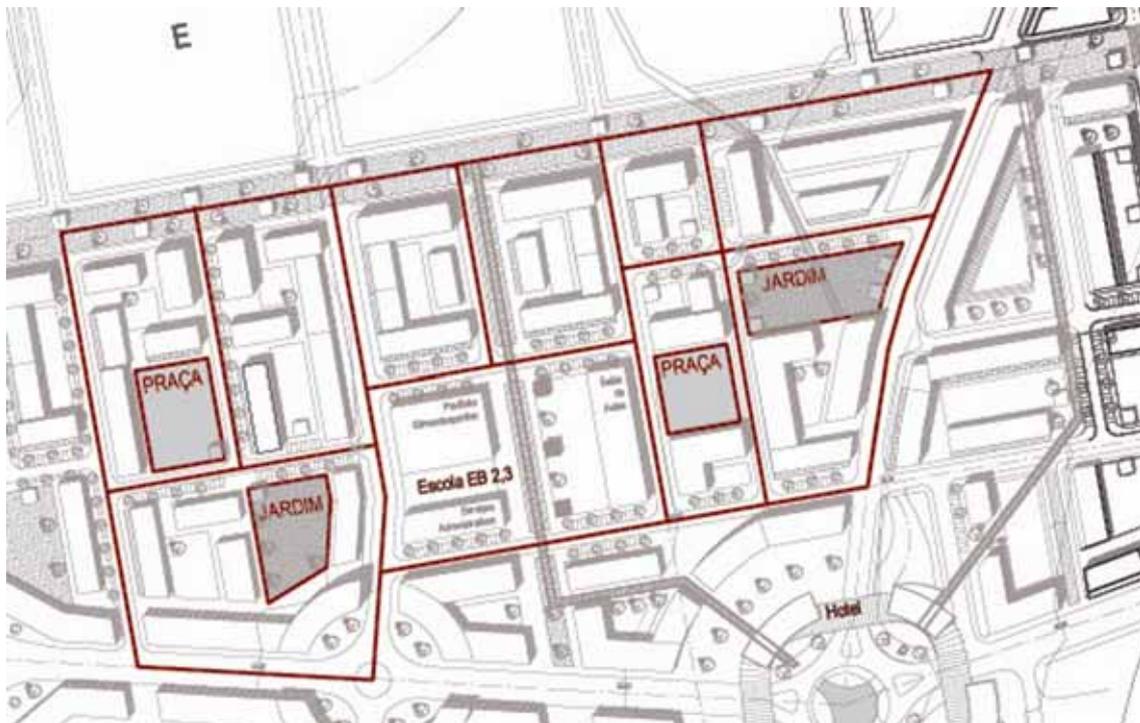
Plano de detalhe Redline – Planta com indicação das unidades urbanas.
